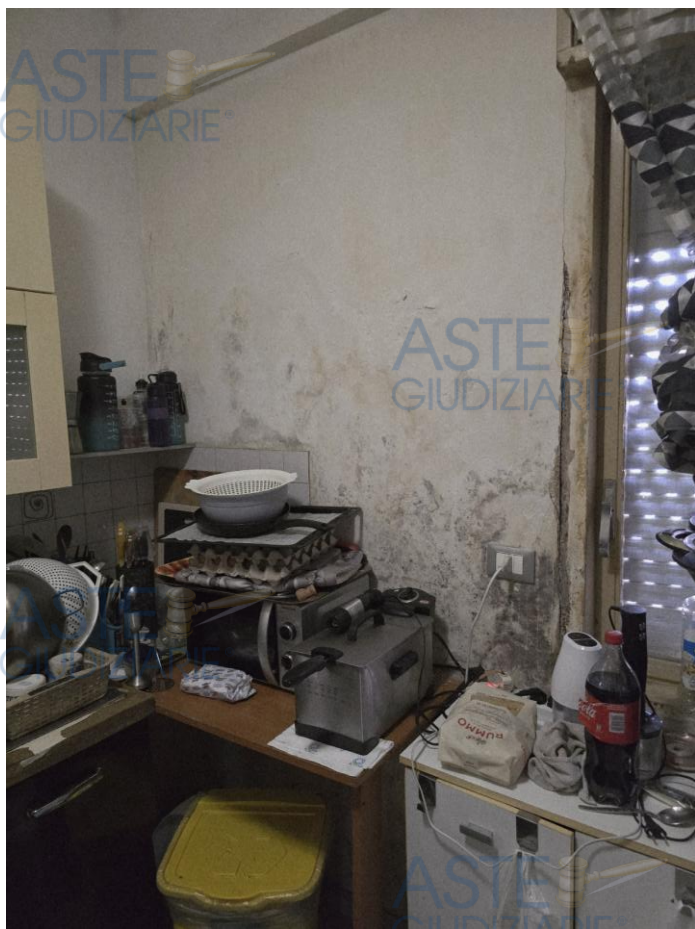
Forte umidità nella parete della cucina che confina con la scala. Vedi la pianta che segue.
